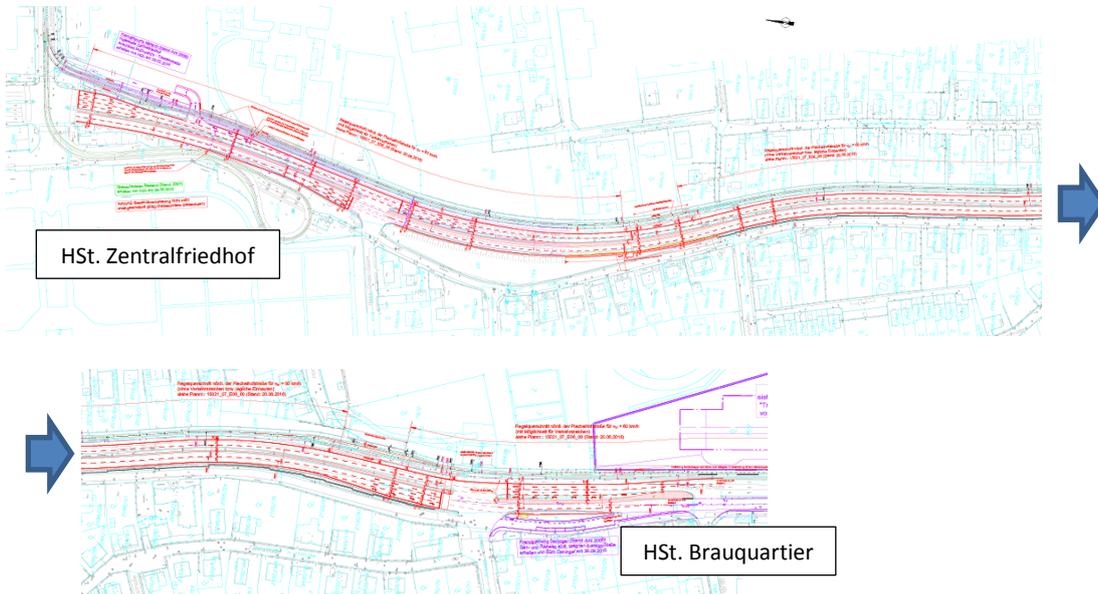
Lageplan Ausbau STRAB-Linie 5
